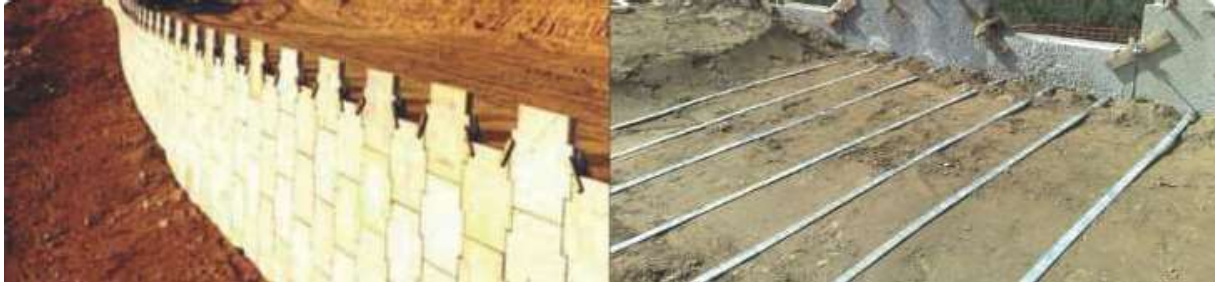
Terra Armada (Reinforced Earth, 2014).
